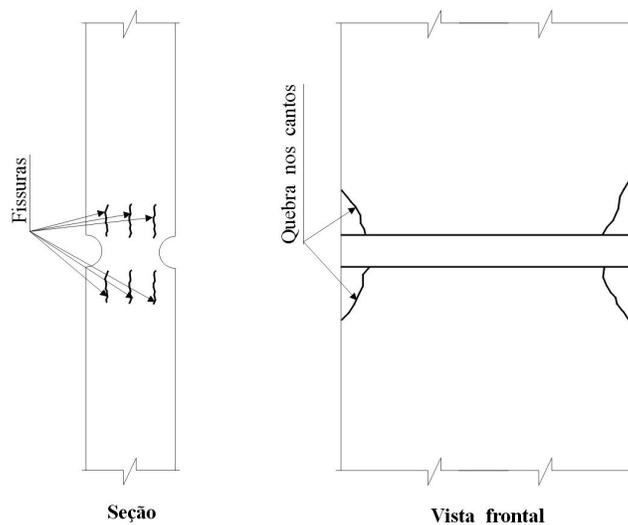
Fissuras nas faces laterais e quebra nos cantos das articulações Freyssinet
